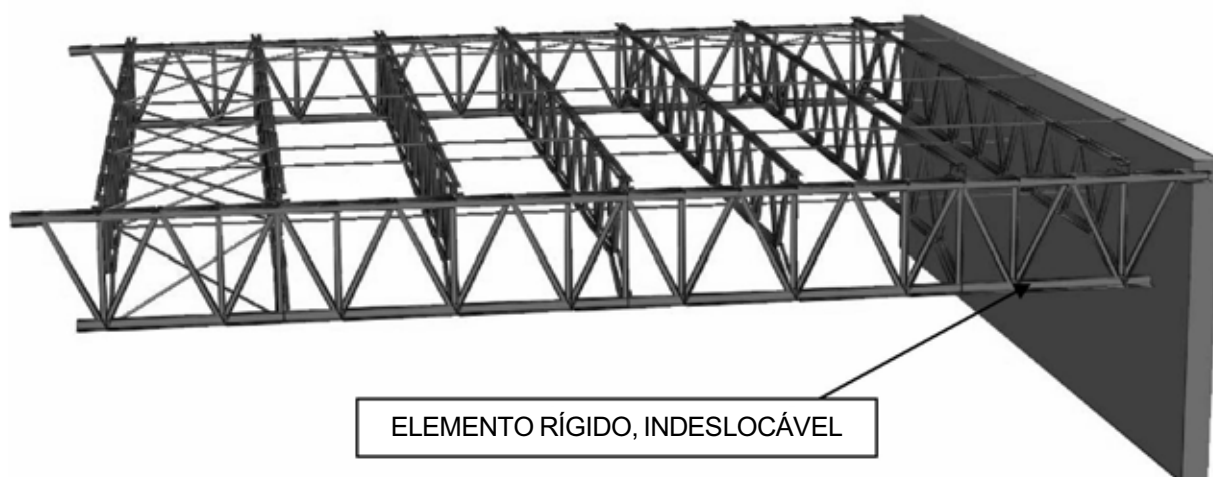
Isométrica Esquemática do Travamento Horizontal em Elemento Rígido
